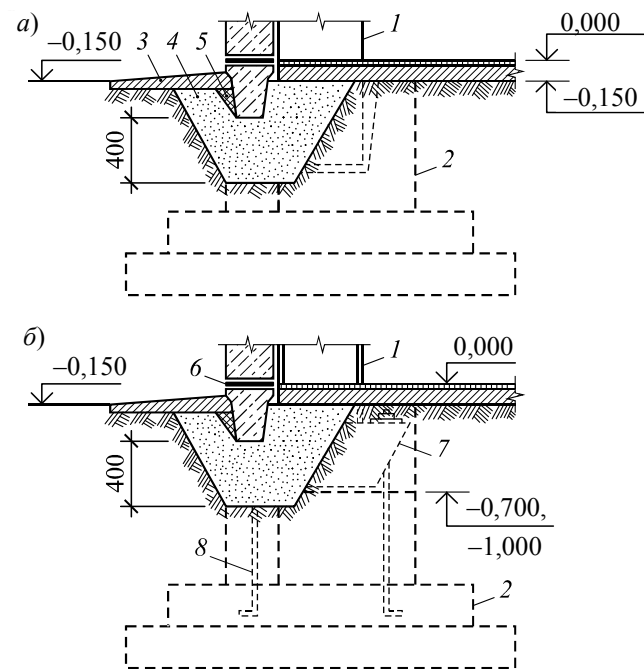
Отдельные фундаменты под железобетонную (а) и стальную (б) колонны постоянного сечения для зданий без подвалов: 1 – колонна; 2 – фундамент; 3 – отсыпка; 4 – шлак; 5 – глиняный замок; 6 – противокapиллярная гидроизоляция; 7 – траверса; 8 – анкерный болт
